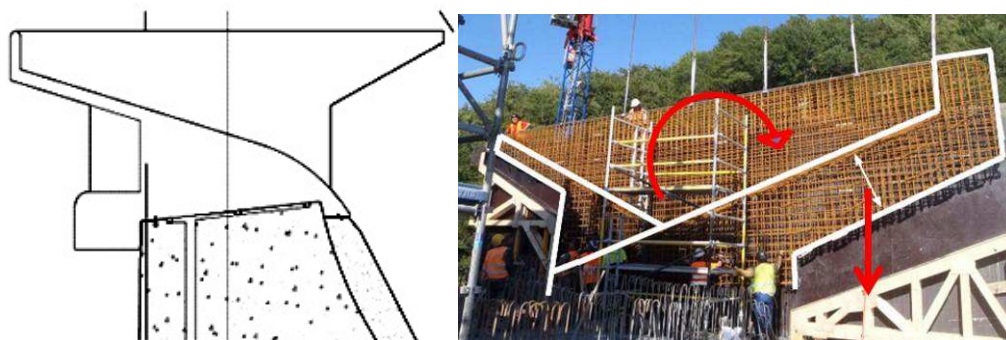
a) Interface PKW/ barrage avec un angle de 5 deg. et poutre « clé de cisaillement » amont, b) Préfabrication du ferrailage d'un mur latéral avec épaissement du radier amont
